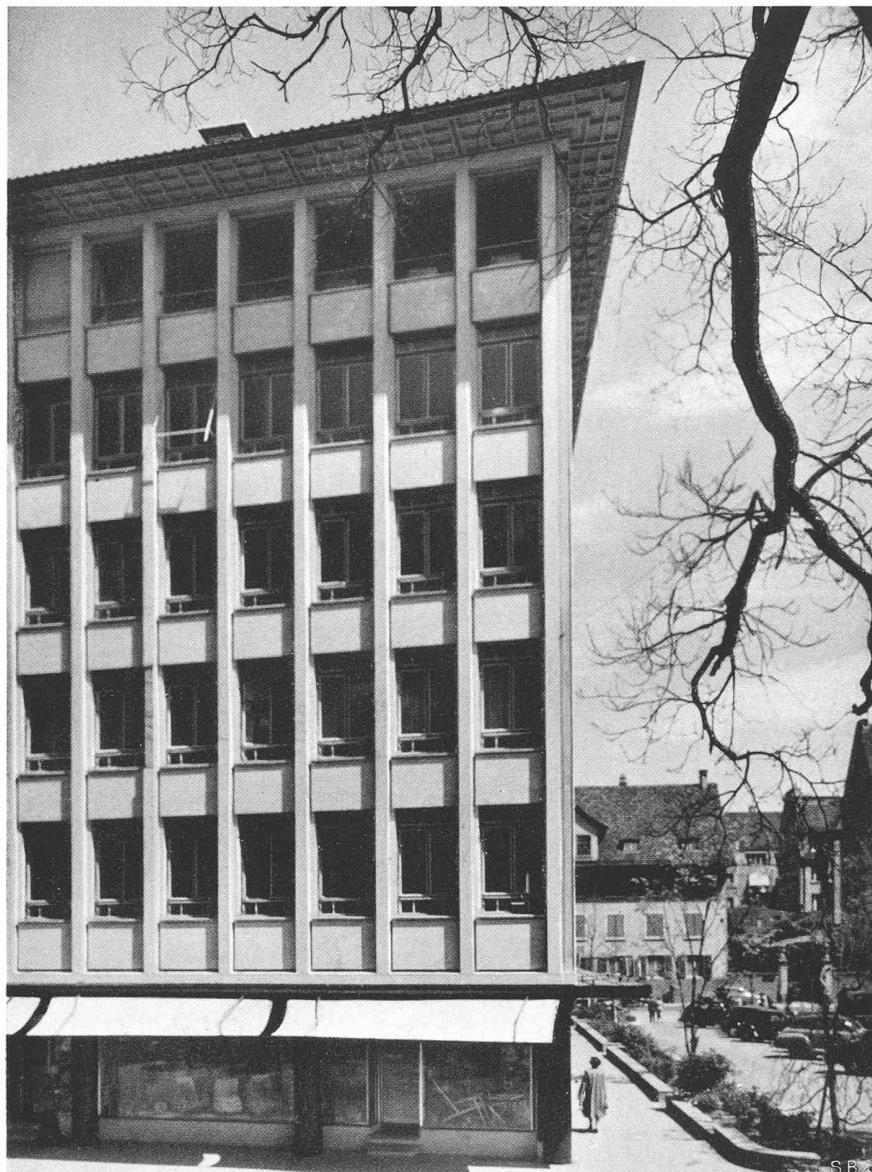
Detail der Fassade an der Talstrasse, rechts der private Parkplatz
